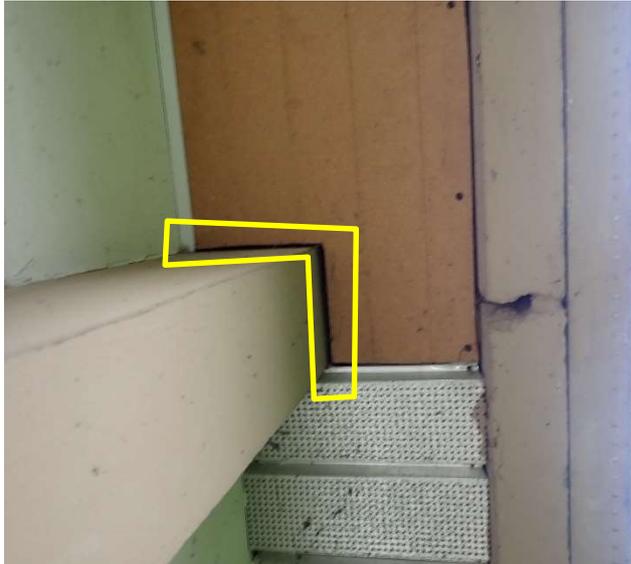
Défaut d'étanchéité au niveau d'un coffrage remplaçant une grille d'aération
